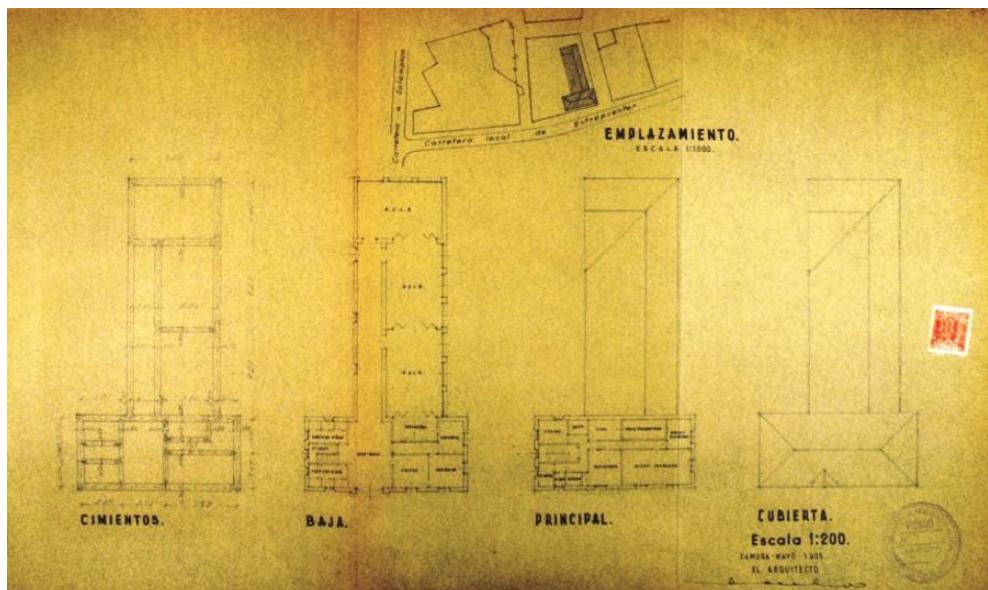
Plano de plantas y emplazamiento. AHPZa. DPV. 32/24.
